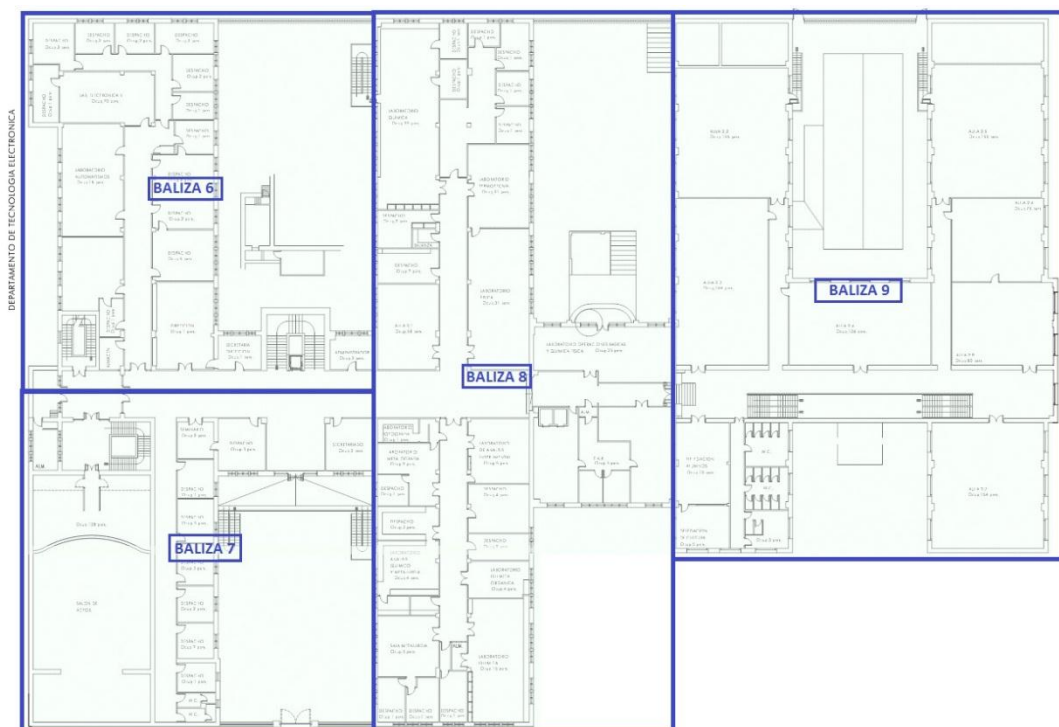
Plano balizas primera planta con sectorizado entre plantas
